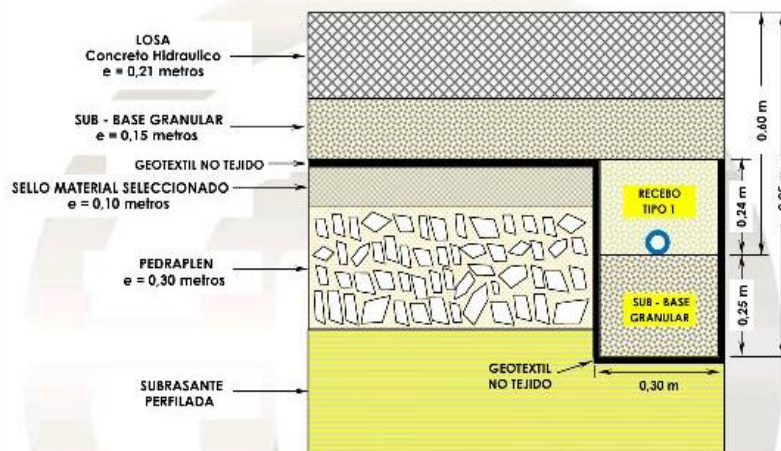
ESTRUCTURA EQUIVALENTE PARA PAVIMENTO RIGIDO SECTOR TUBERIA DE GAS
